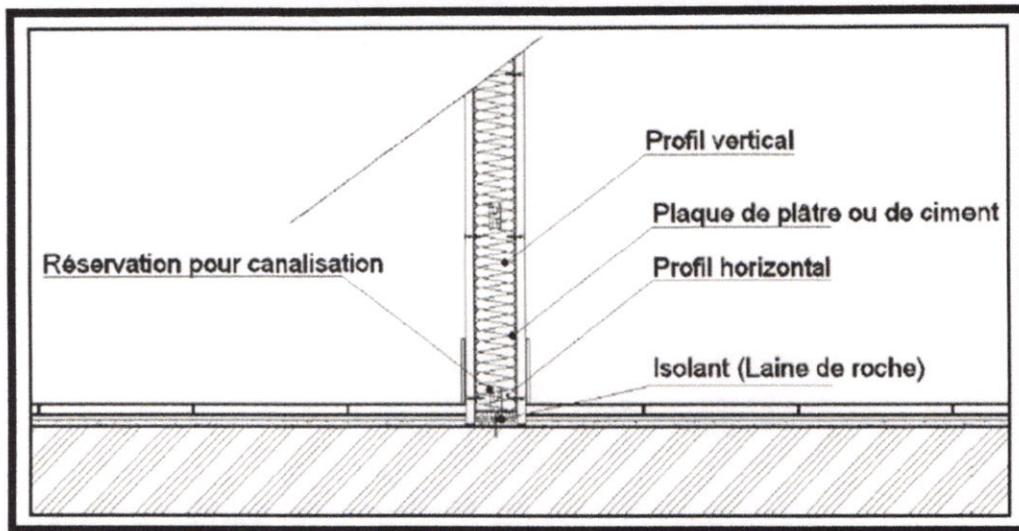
Détail de fixation de plaque au plâtre ou de ciment
